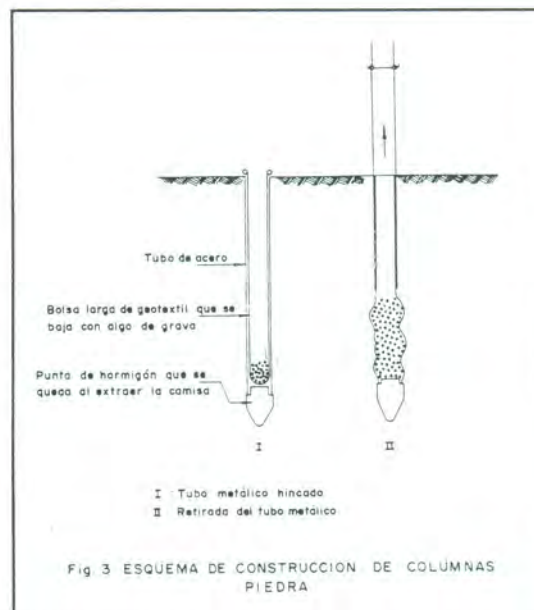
ESQUEMA DE CONSTRUCCION DE COLUMNAS PIEDRA
